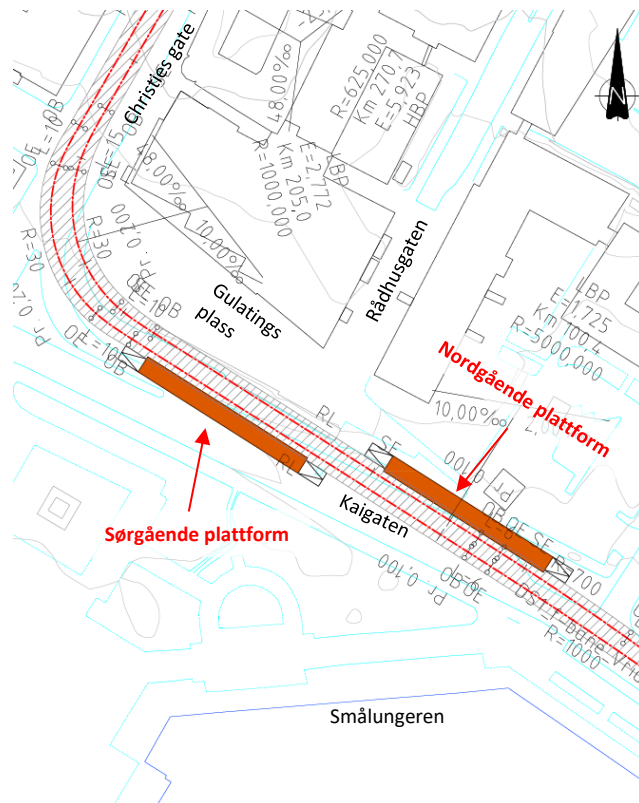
Plan-tegning av tunnelalternativet i dagen mellom Kaigaten og tunnelpåhugget ved Heggebakken.
